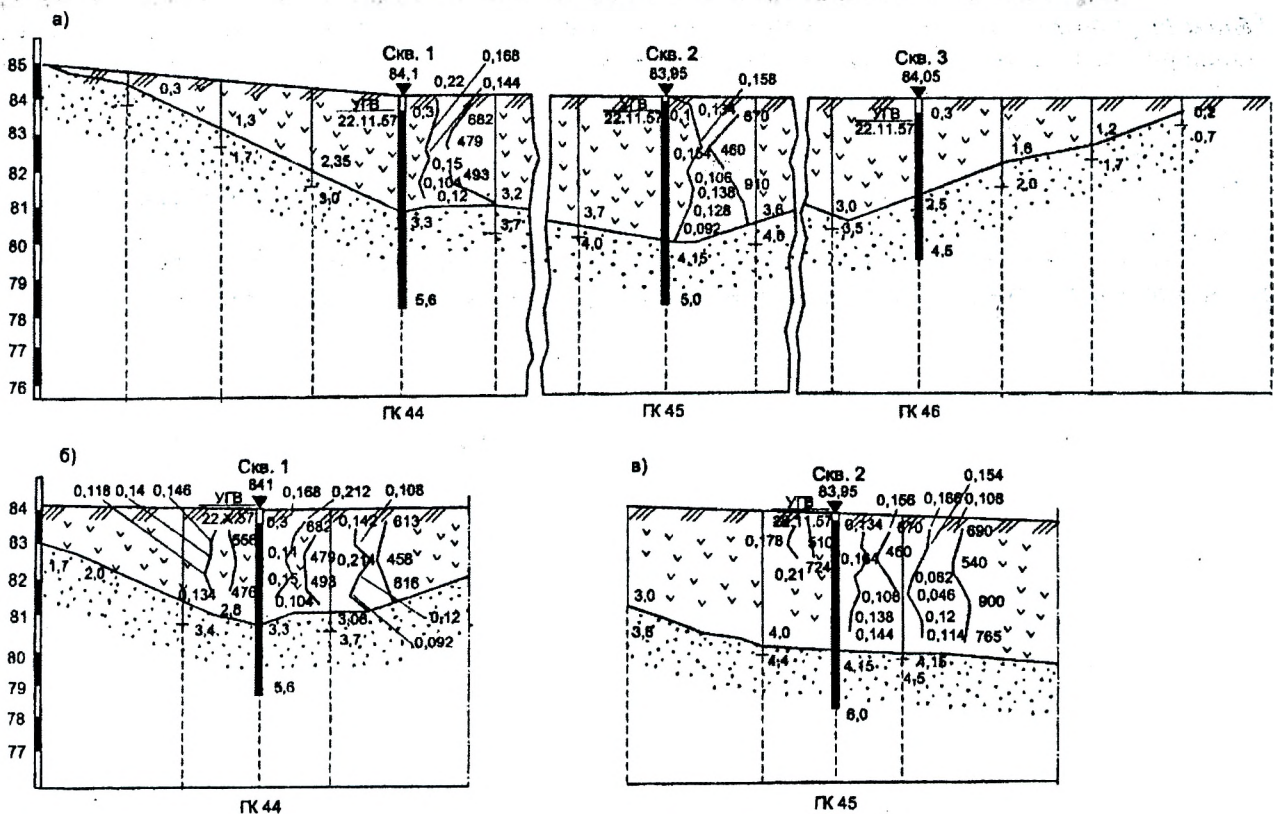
Геологические разрезы по трассе: а – продольный разрез по оси дороги; б – поперечный разрез на ГК 44; в – поперечный разрез на ГК 45. Расстояние между скважинами – 25 м
